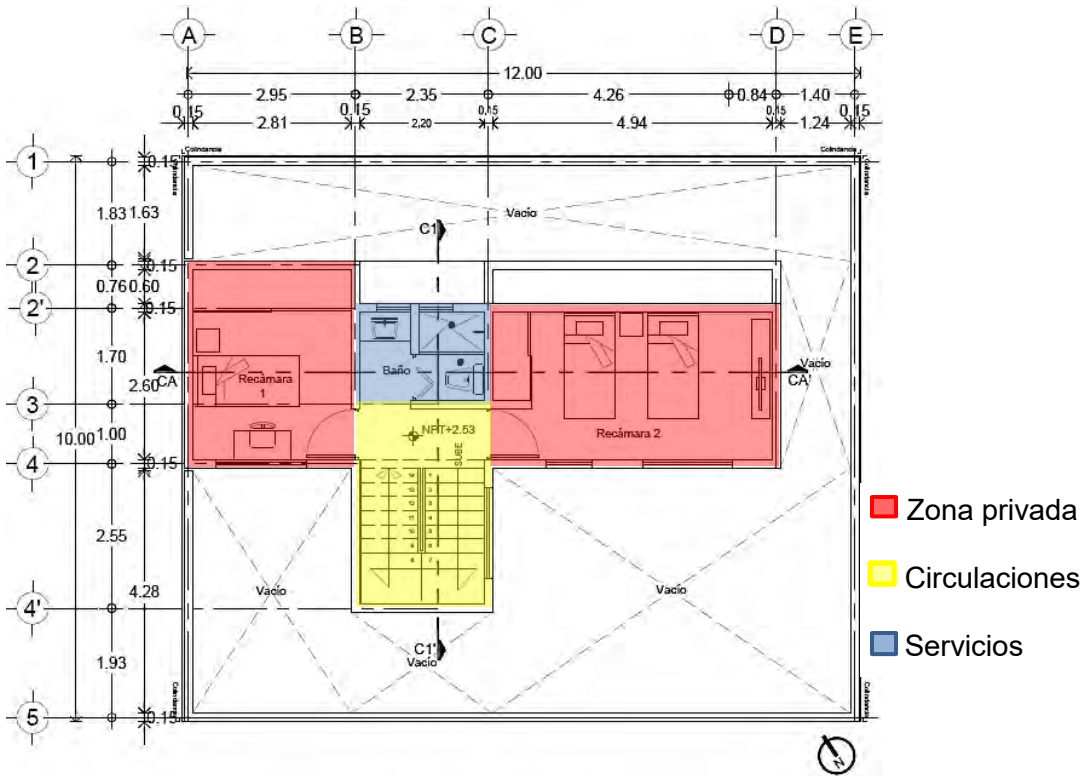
Planta arquitectónica del prototipo de vivienda C2. Tercera etapa, primer nivel.
